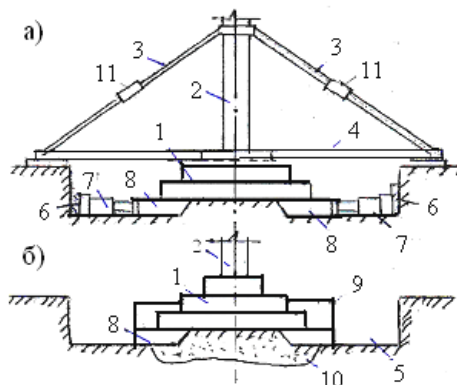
Усиление фундамента вдавливанием элементов уширения под существующую подошву фундамента:
